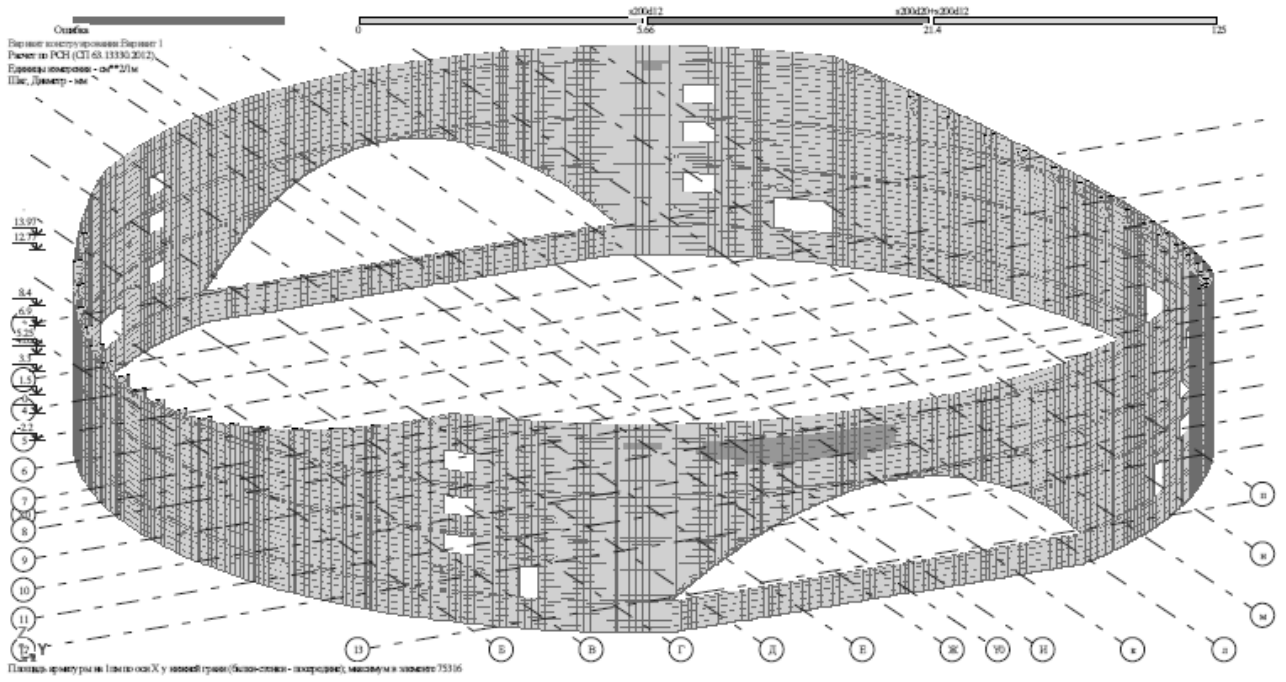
Расчетное армирование стен по оси X у нижней и верхней грани
